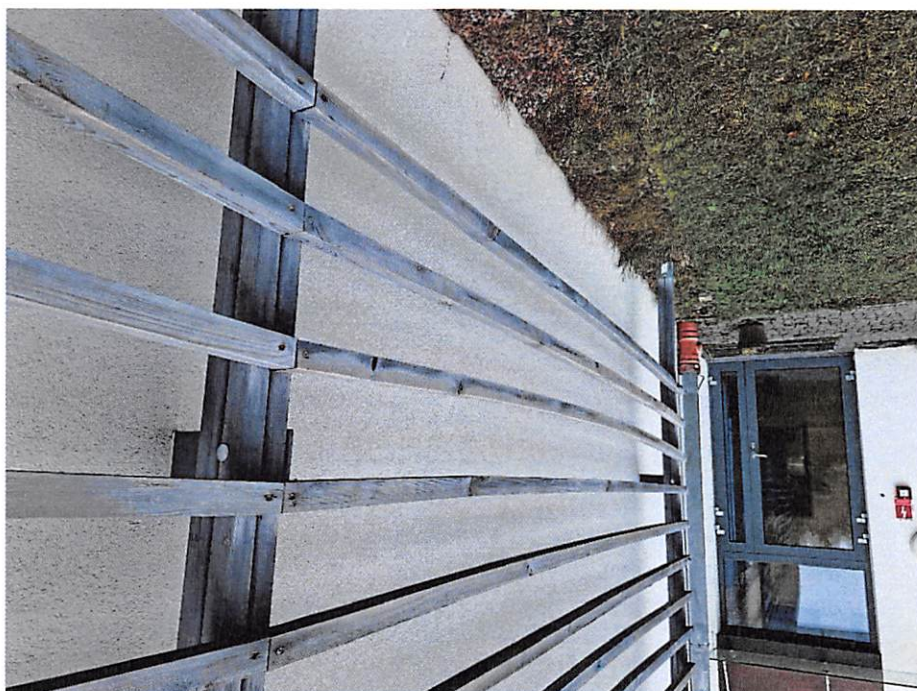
Pęknięcia tynku na elewacji ściany szczytowej sali gimnastycznej.
